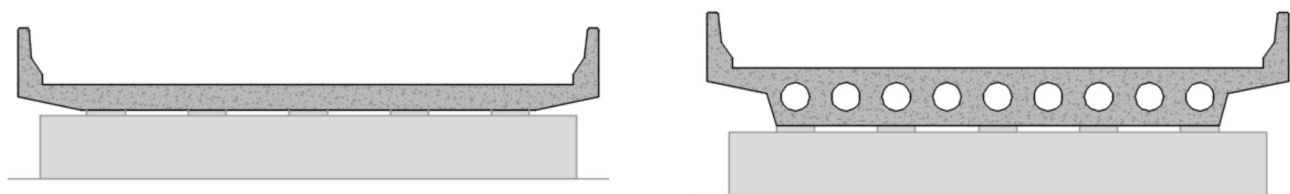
Seções transversais típicas de pontes e viadutos em laje maciça e vazada respectivamente.
